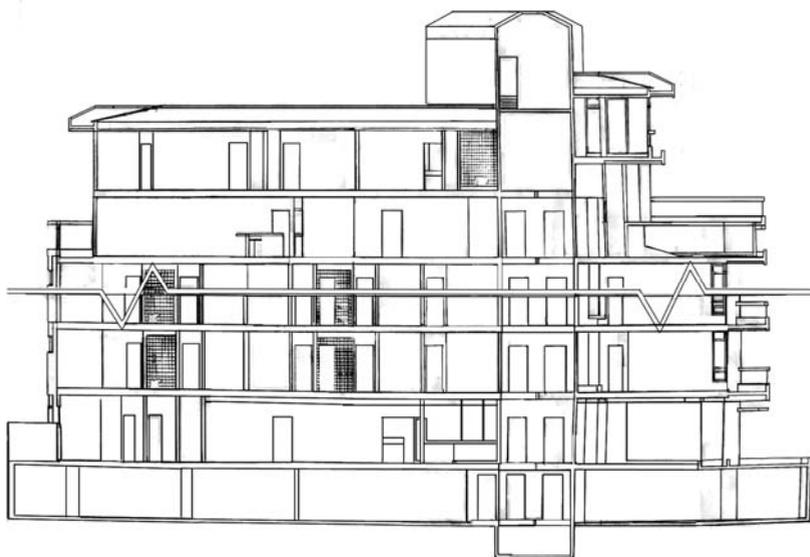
Corte longitudinal do edifício Guarazes com dez pavimentos.
